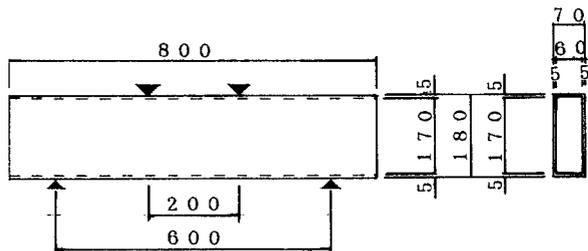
被覆拘束補強コンクリート梁-1,2の形状及び寸法
